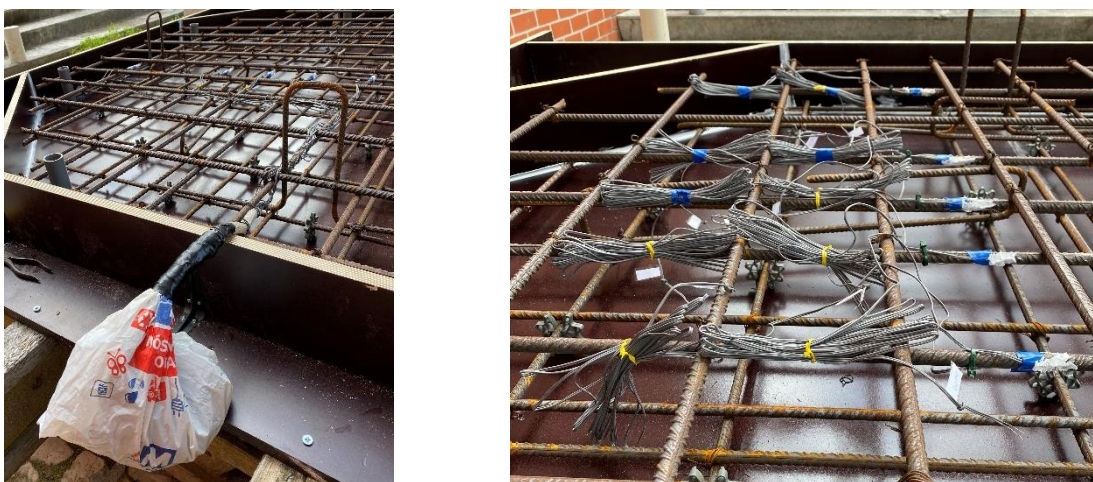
Extensómetros eléctricos localizados na armadura superior
